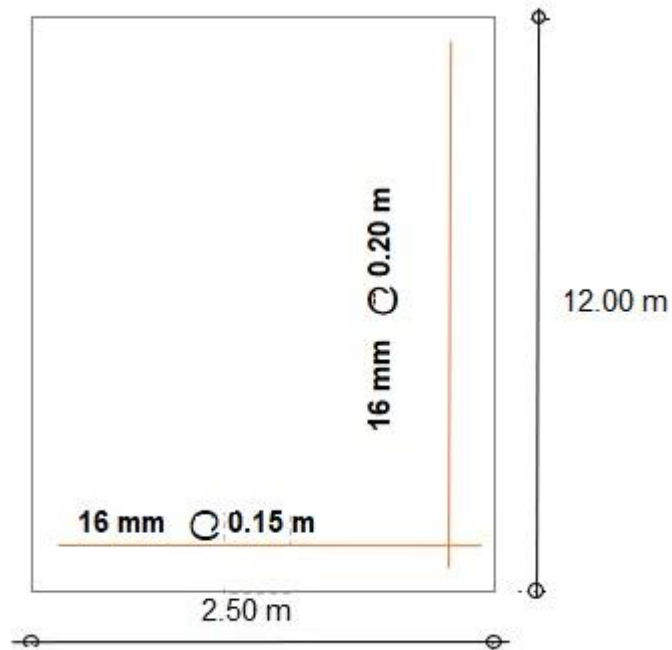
Armado de la zapata (Vista superior) Fuente: Propia
